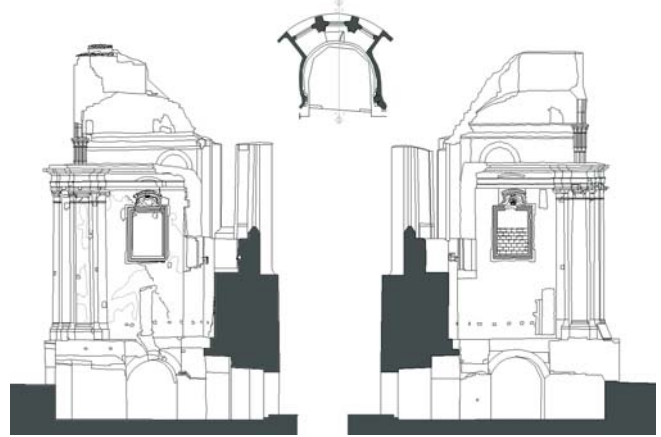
Sezioni sull'abside: editing della restituzione fotogrammetrica (originale in scala 1:50)
